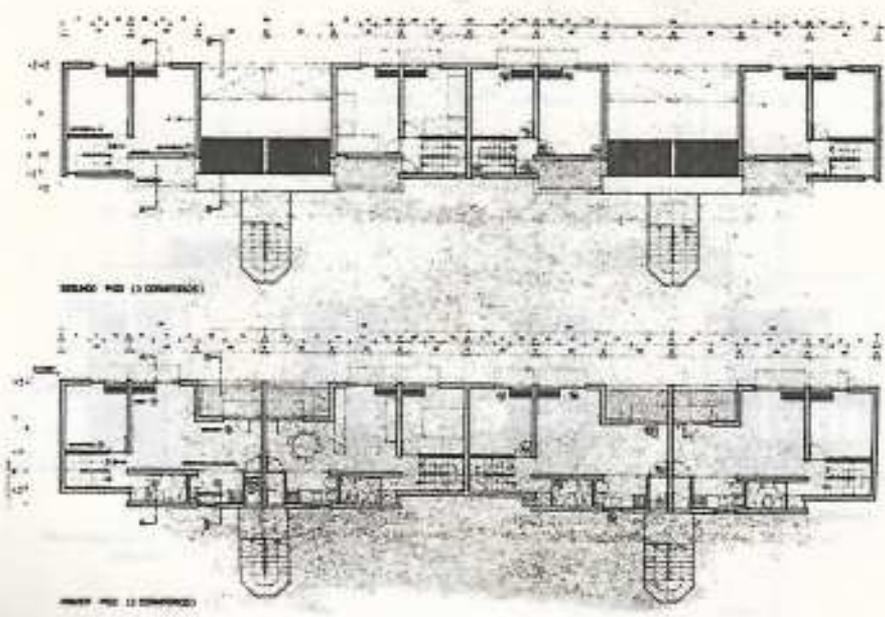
Viviendas en cinta. Plantas de primero y segundo pisos, con muro solar
